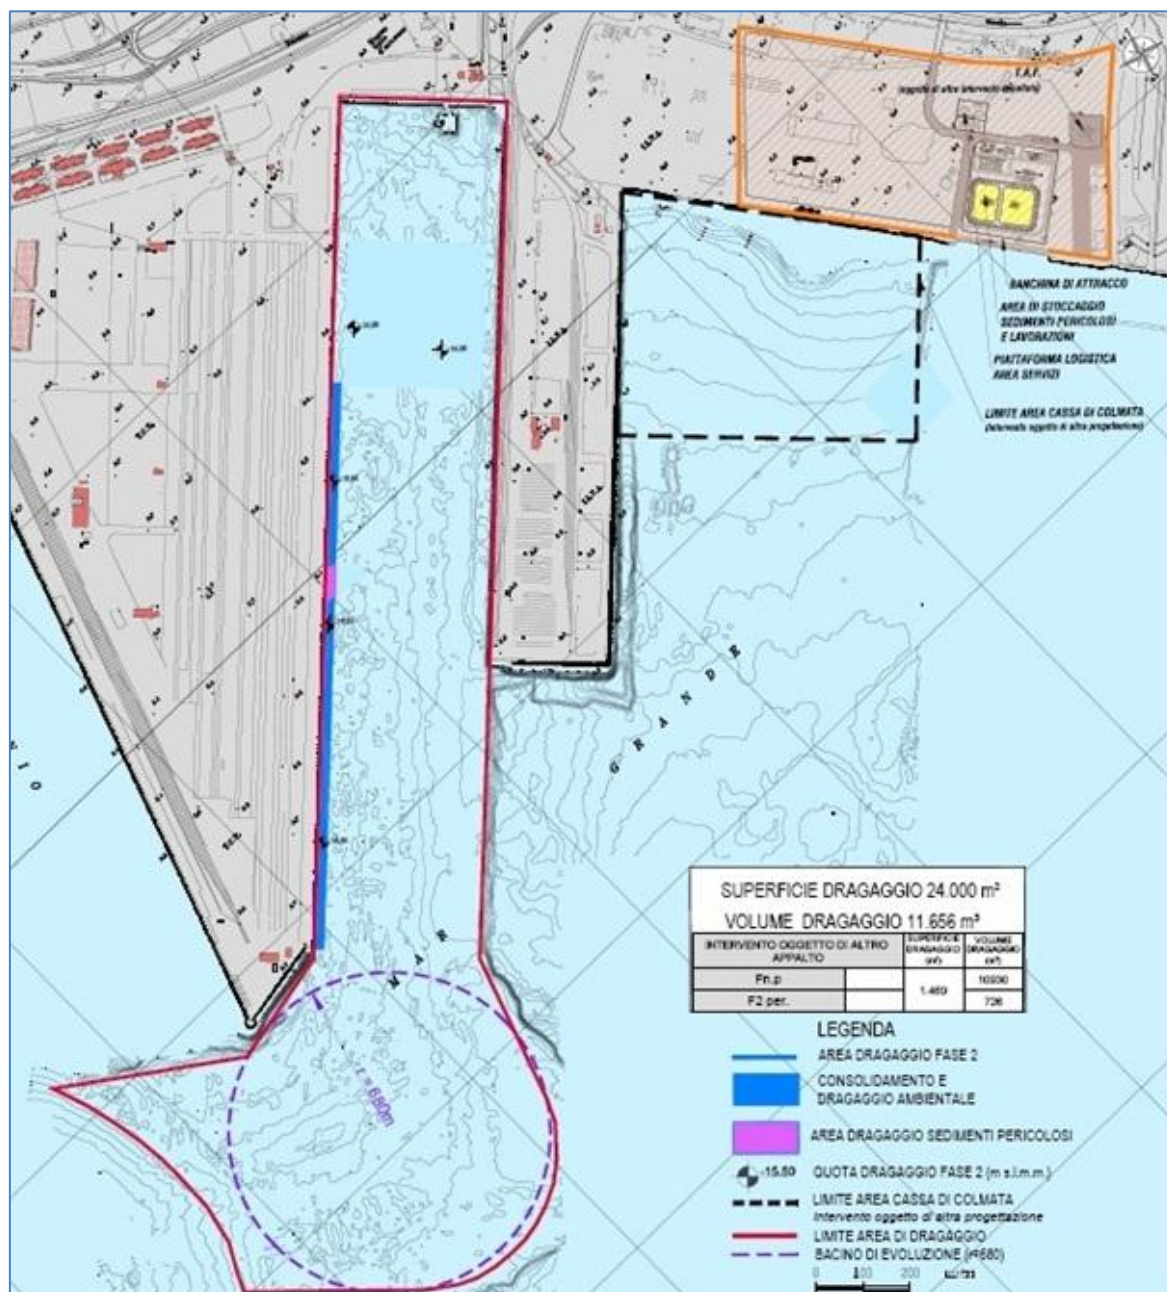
Fase 2 del progetto di dragaggio Darsena Polisettoriale (in carico a TCT)
